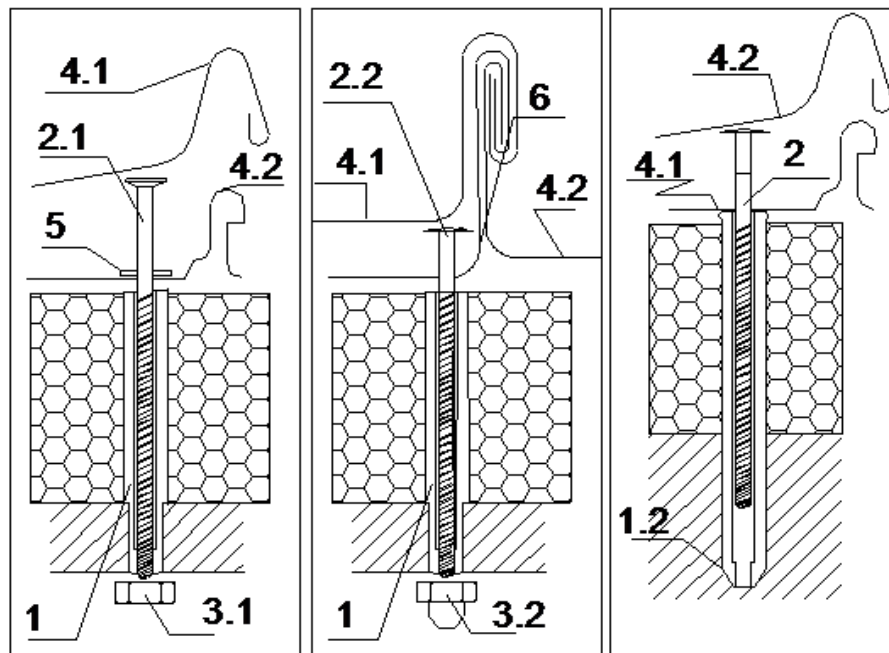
Схема крепления утеплителя на металлические и деревянные стропила:
